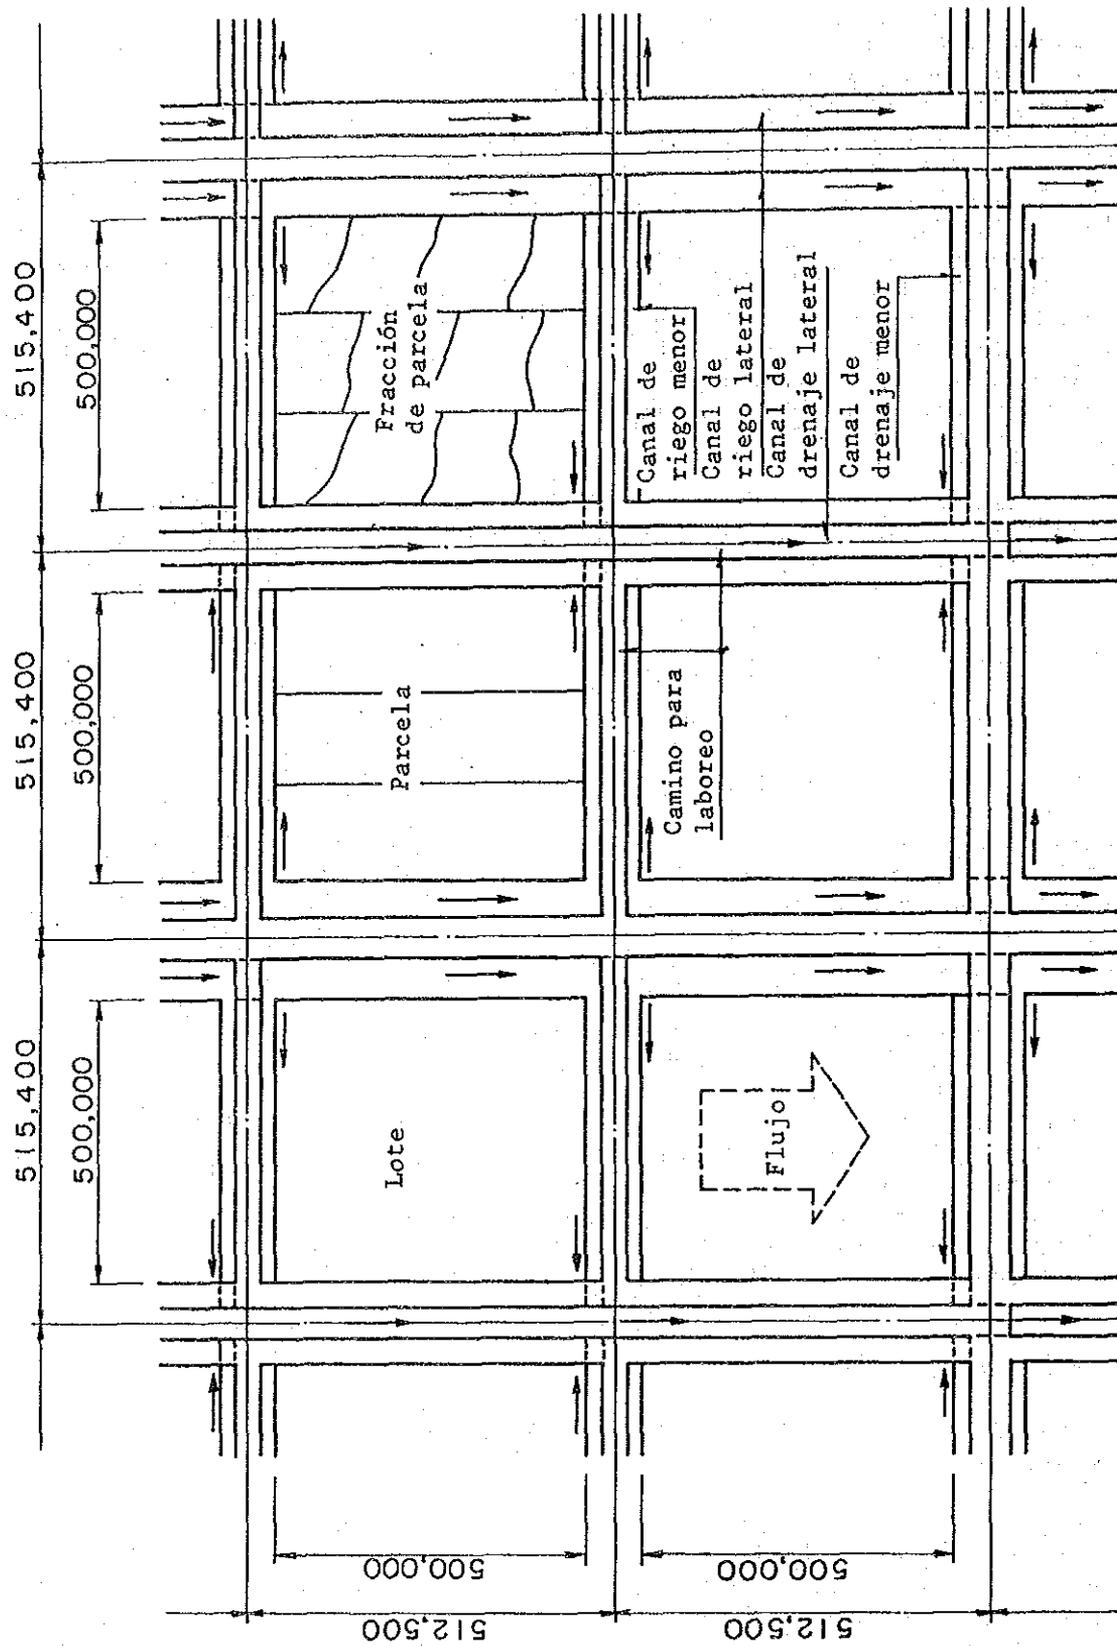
PLANO ESQUEMATICO DEL PROYECTO DE HABILITACION DE ARROZALES (Unidad: m)
